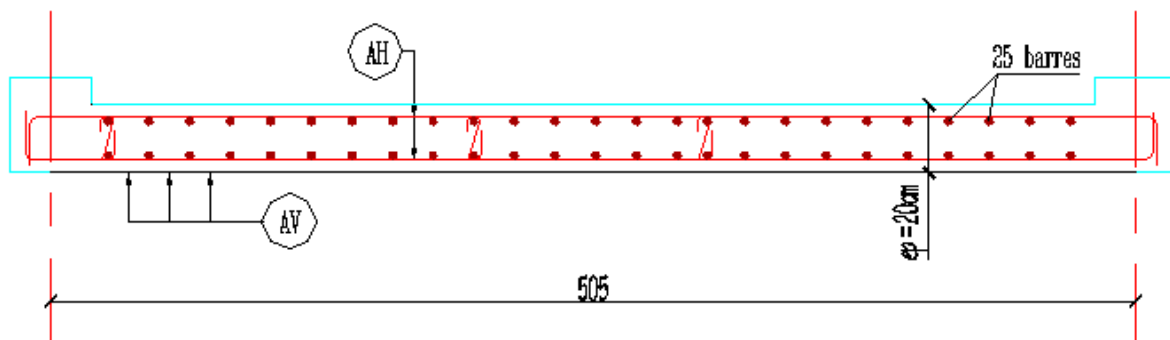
ferrailage de voile type 01 (L=5.05 m)
